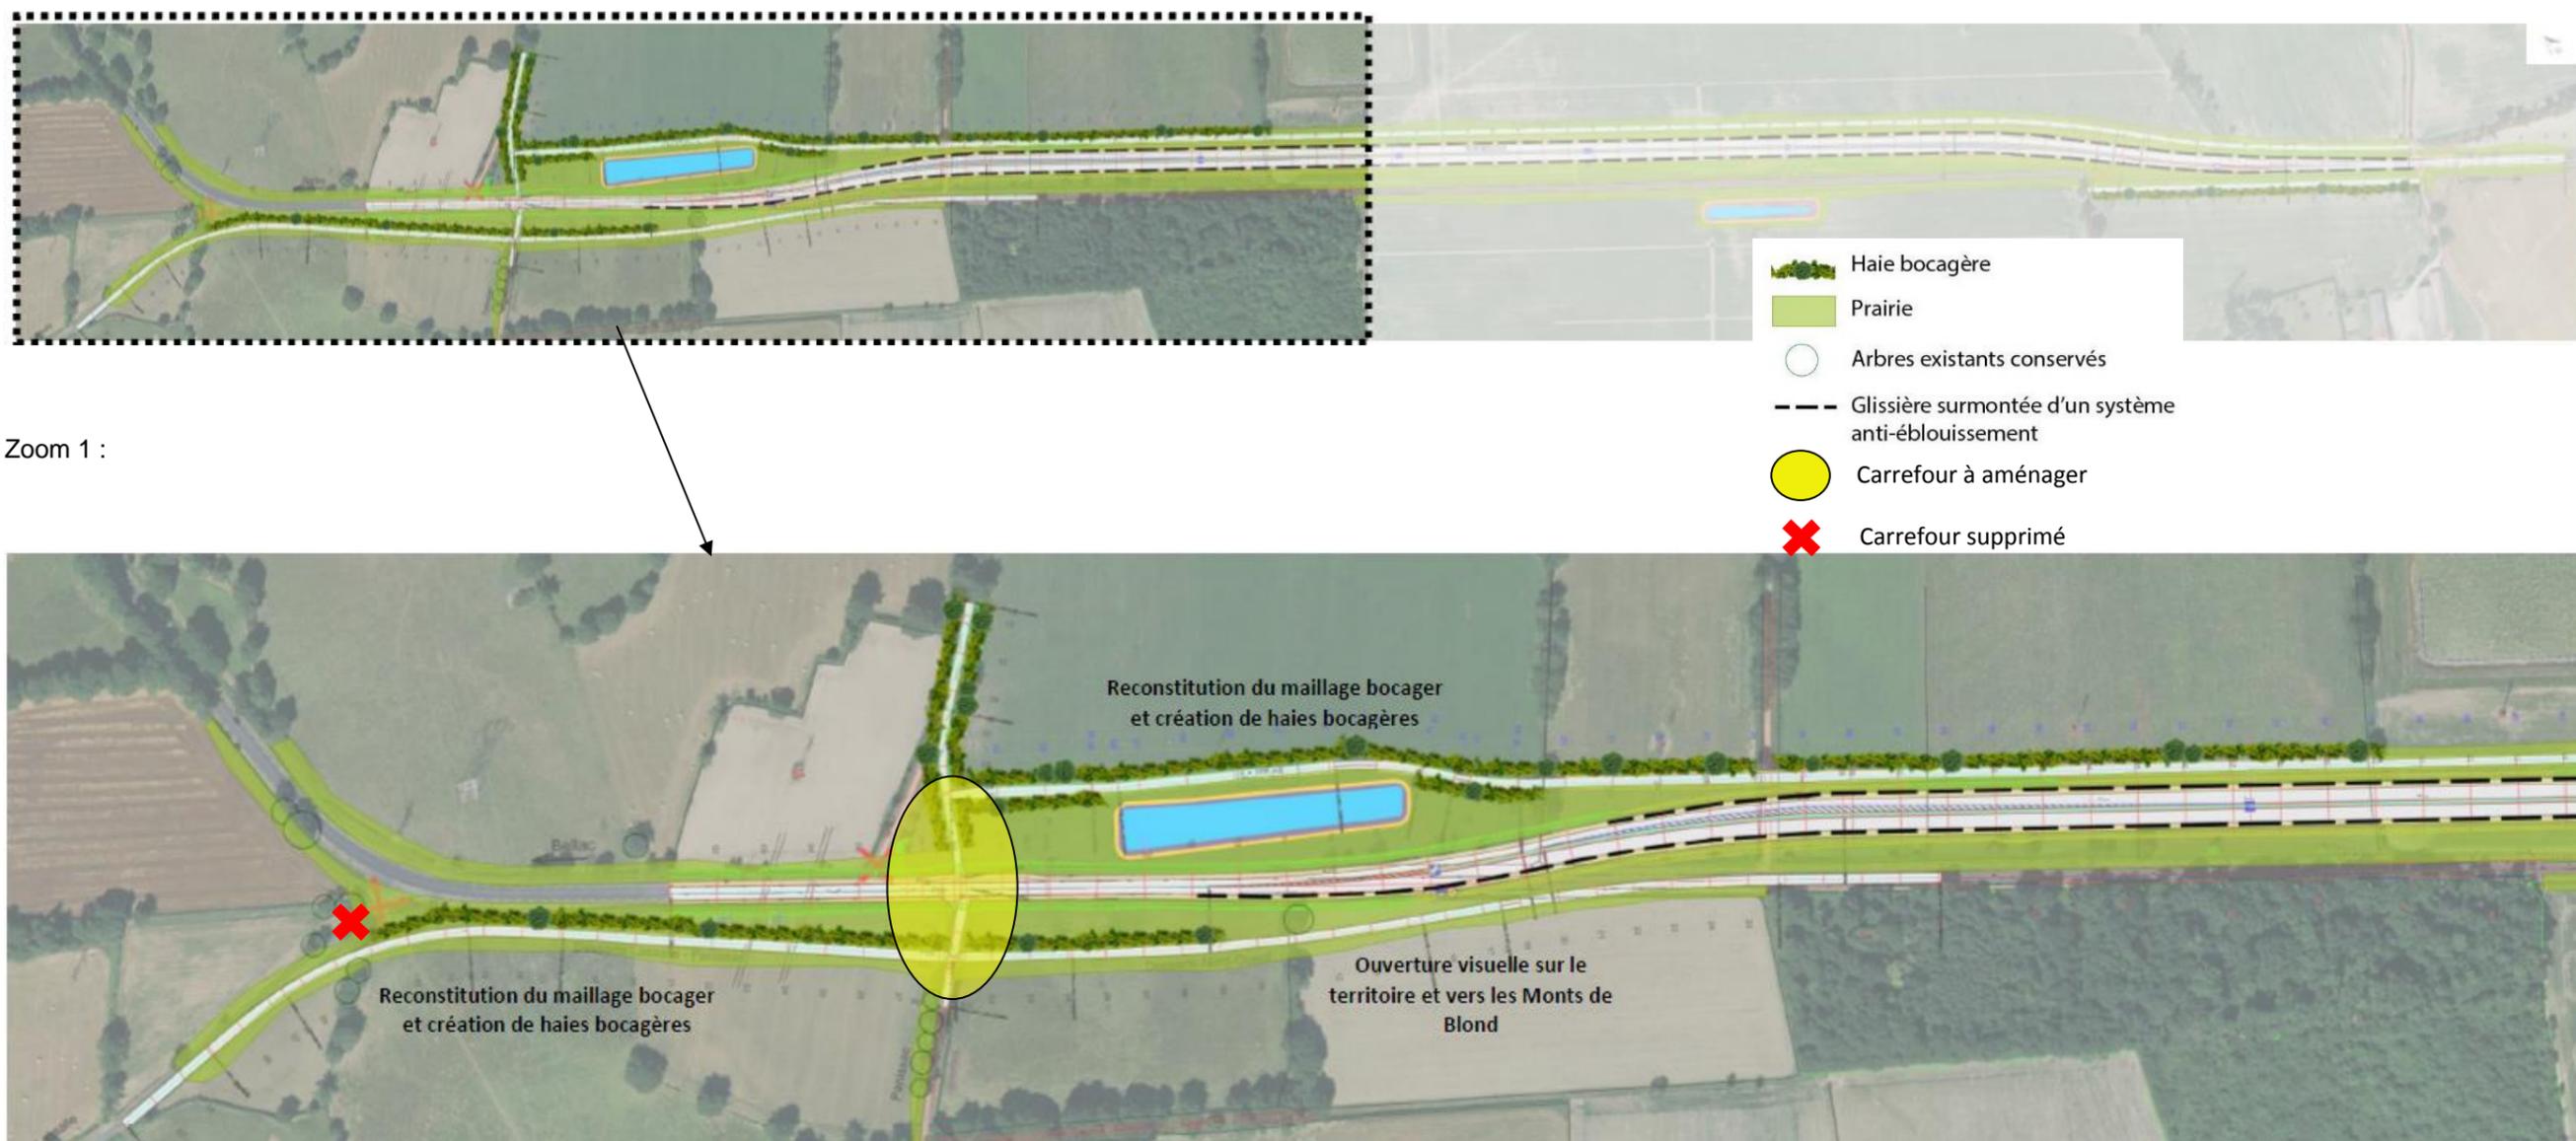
Vue en plan indicative des aménagements paysagers sur le secteur Berneuil – zoom 1
